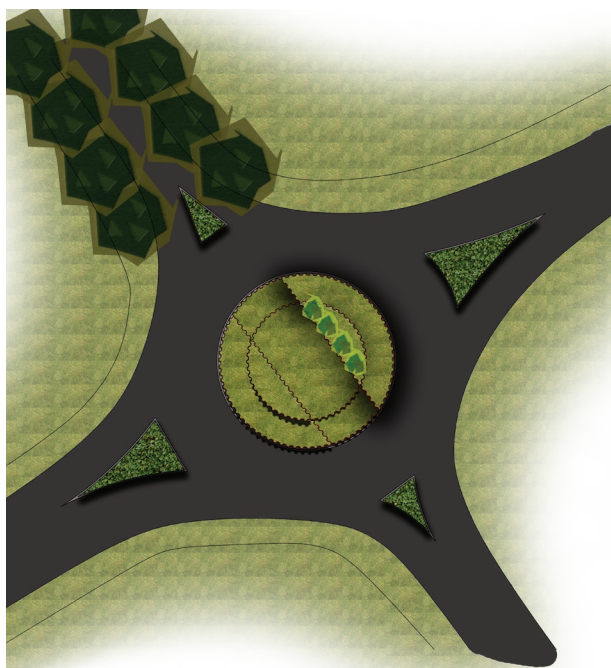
Planta geral da proposta para o projeto de requalificação da rotunda da zona industrial
